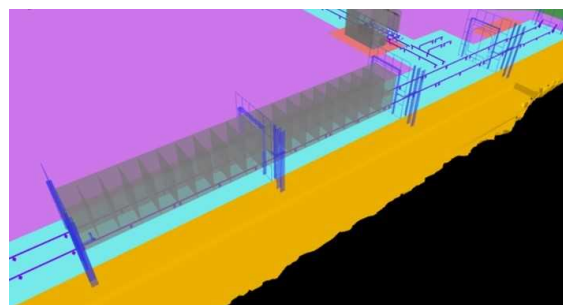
施工 CIM による PCa 部材管理 (基礎通廊)
